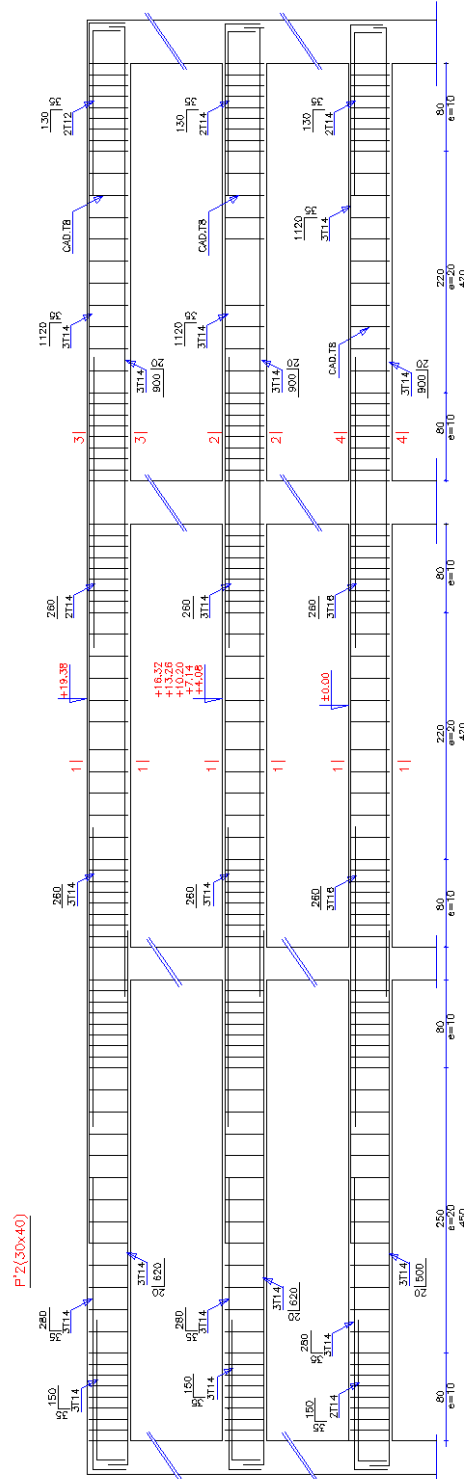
Ferrailage de la poutre principale (30x40) cm<sup>2</sup>
